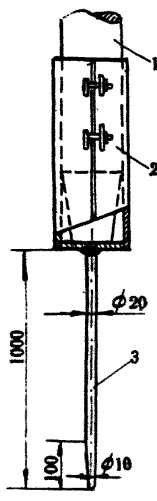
Приспособление для уплотнения раствора в вертикальных стыках: 1 - вибратор; 2 - насадка; 3 - игольчатый наконечник
